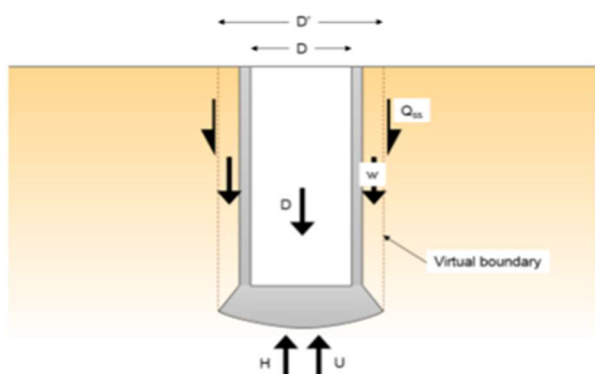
Losa de fondo. Diseño frente a subpresión y heave
